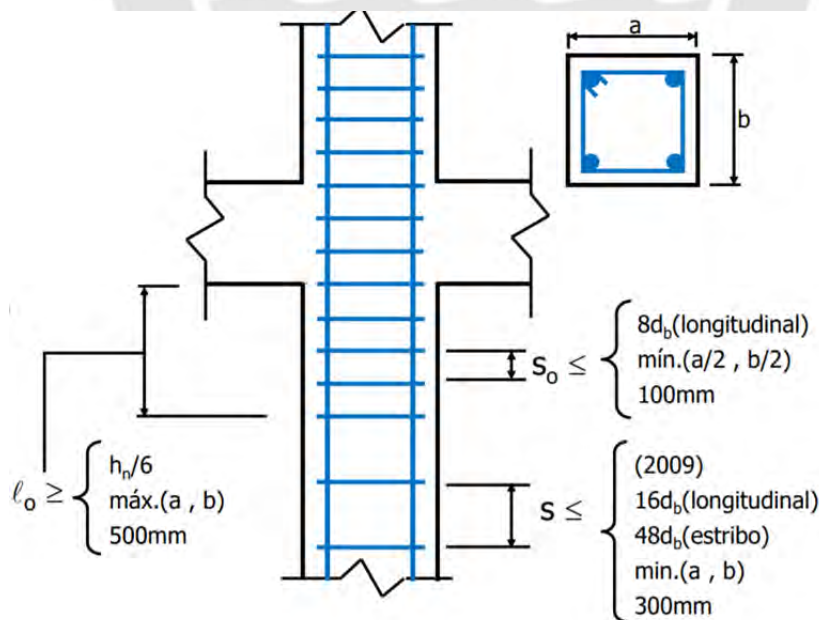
Distribución del espaciamiento del estribo en columnas
